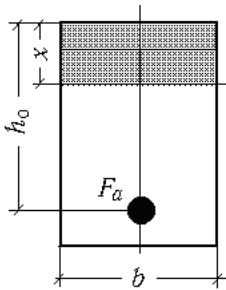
Нормальное сечение изгибаемой железобетонной балки с трещиной при однослойном армировании
